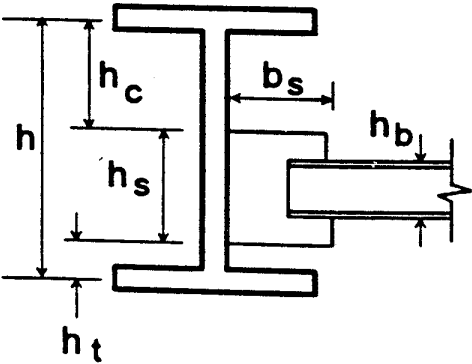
ALMAS DE VIGAS PARCIALMENTE RIGIDIZADAS
